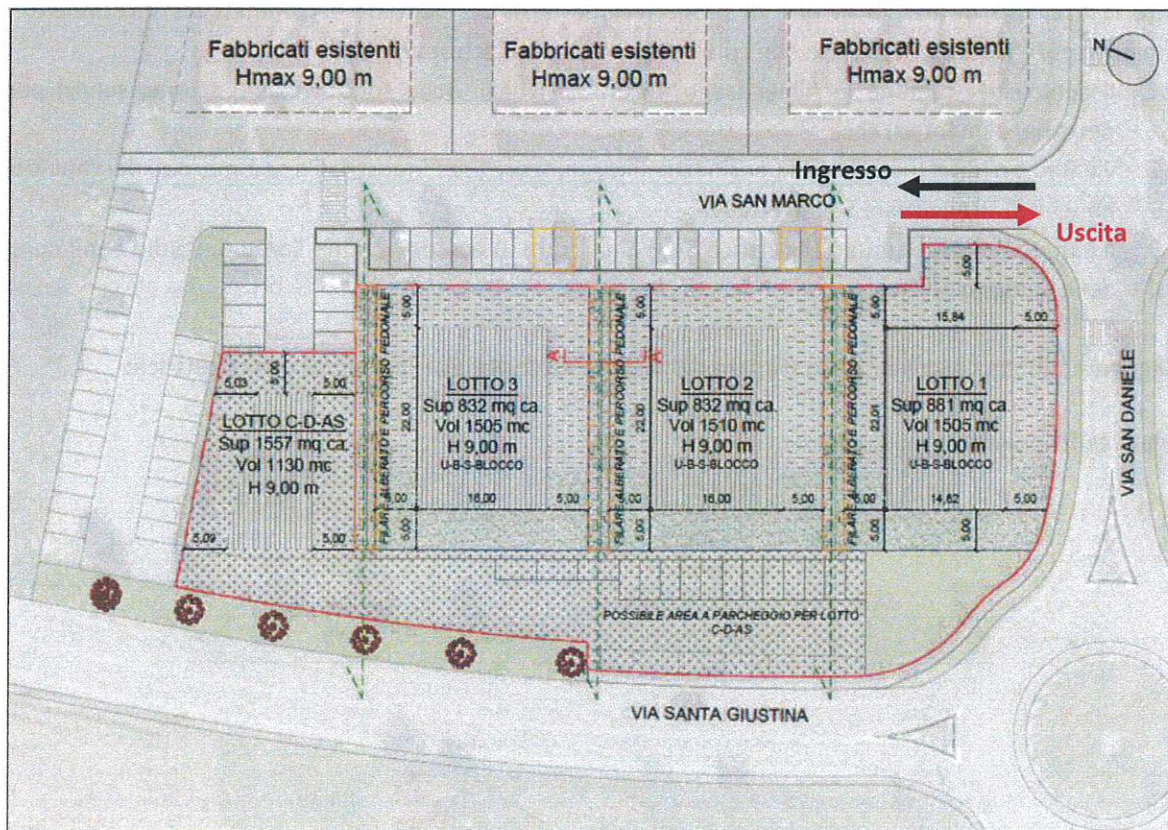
Stralcio planimetria ambito di studio. Accessi.
